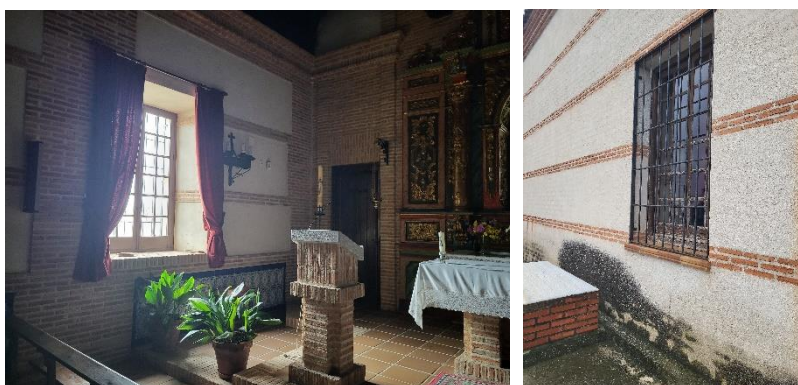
Ventana en el altar con vistas al cementerio, fachada norte. Vista exterior de esta ventana
